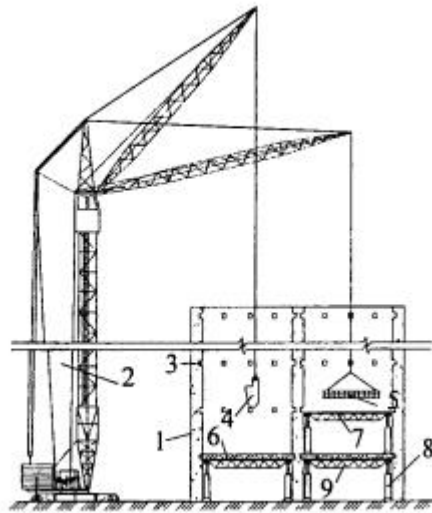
Бетонування міжповерхового перекриття методом «знизу-вгору»: 1 — монолітні стіни; 2 — кран; 3 — залишені при бетонуванні гнізда; 4 — поворотна баддя для подачі бетонної суміші; 5 — армокаркас; 6 — опалубка перекриття; 7 — фермочний прогін; 8 — телескопічна стійка; 9 — монолітне перекриття
